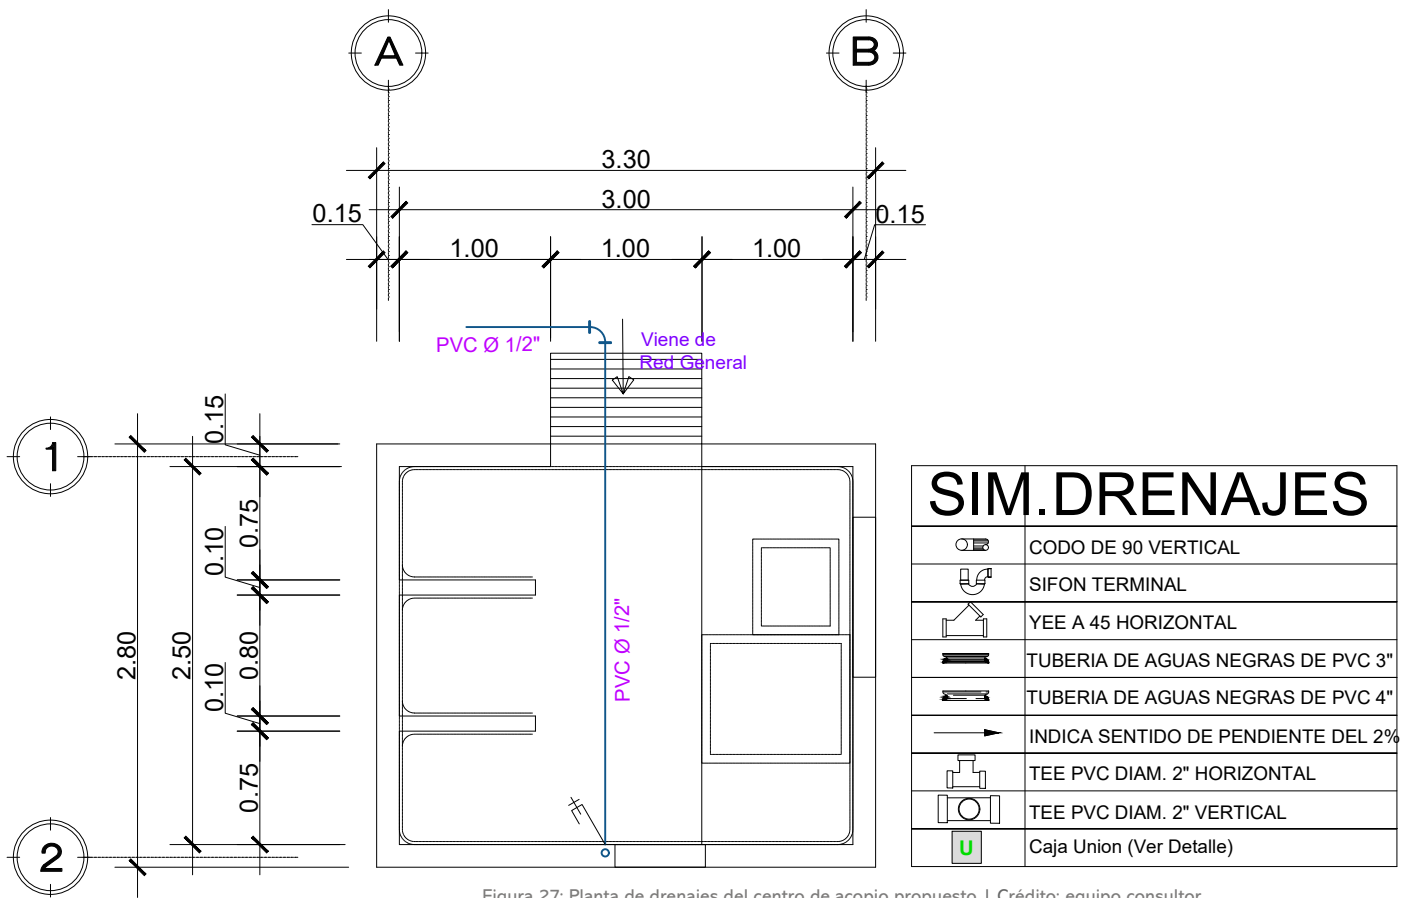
Planta de drenajes del centro de acopio propuesto | Crédito: equipo consultor.
